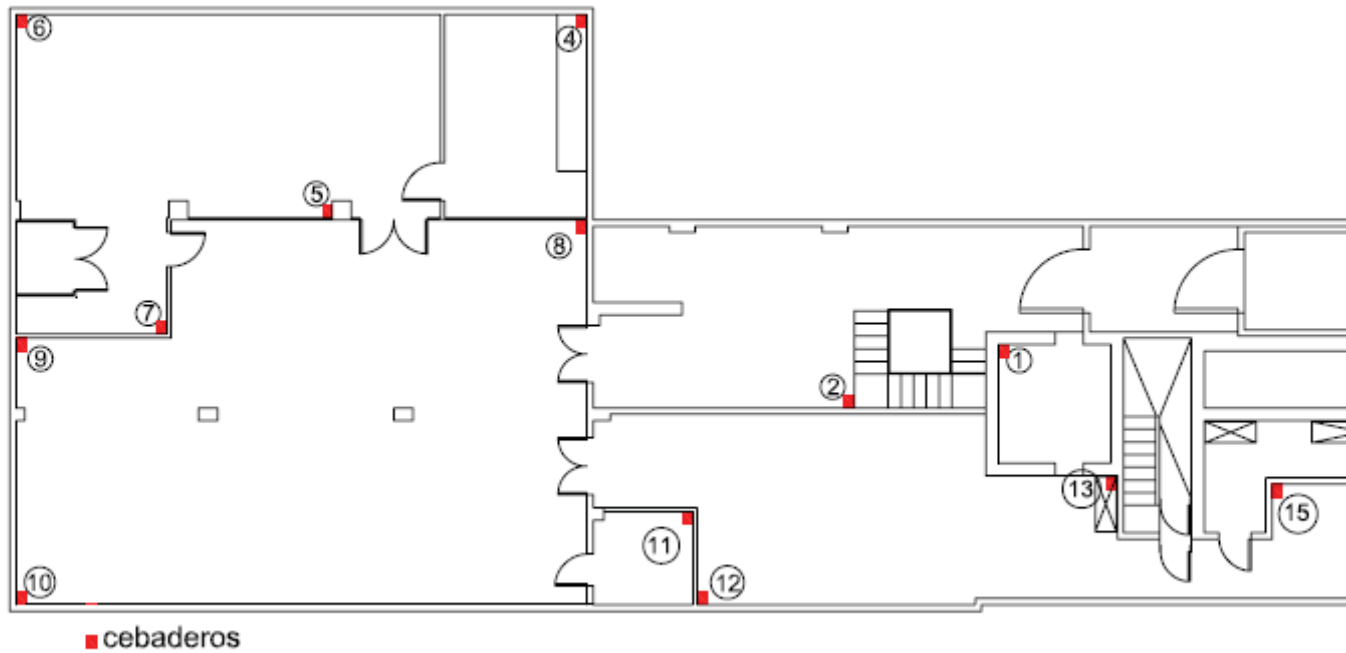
Disposición de los cebaderos con raticida en la planta sótano.
